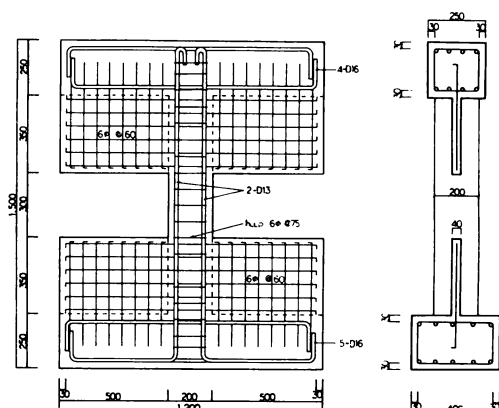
(d) 試験体 CSS04 の配筋図 (寸法単位mm)
